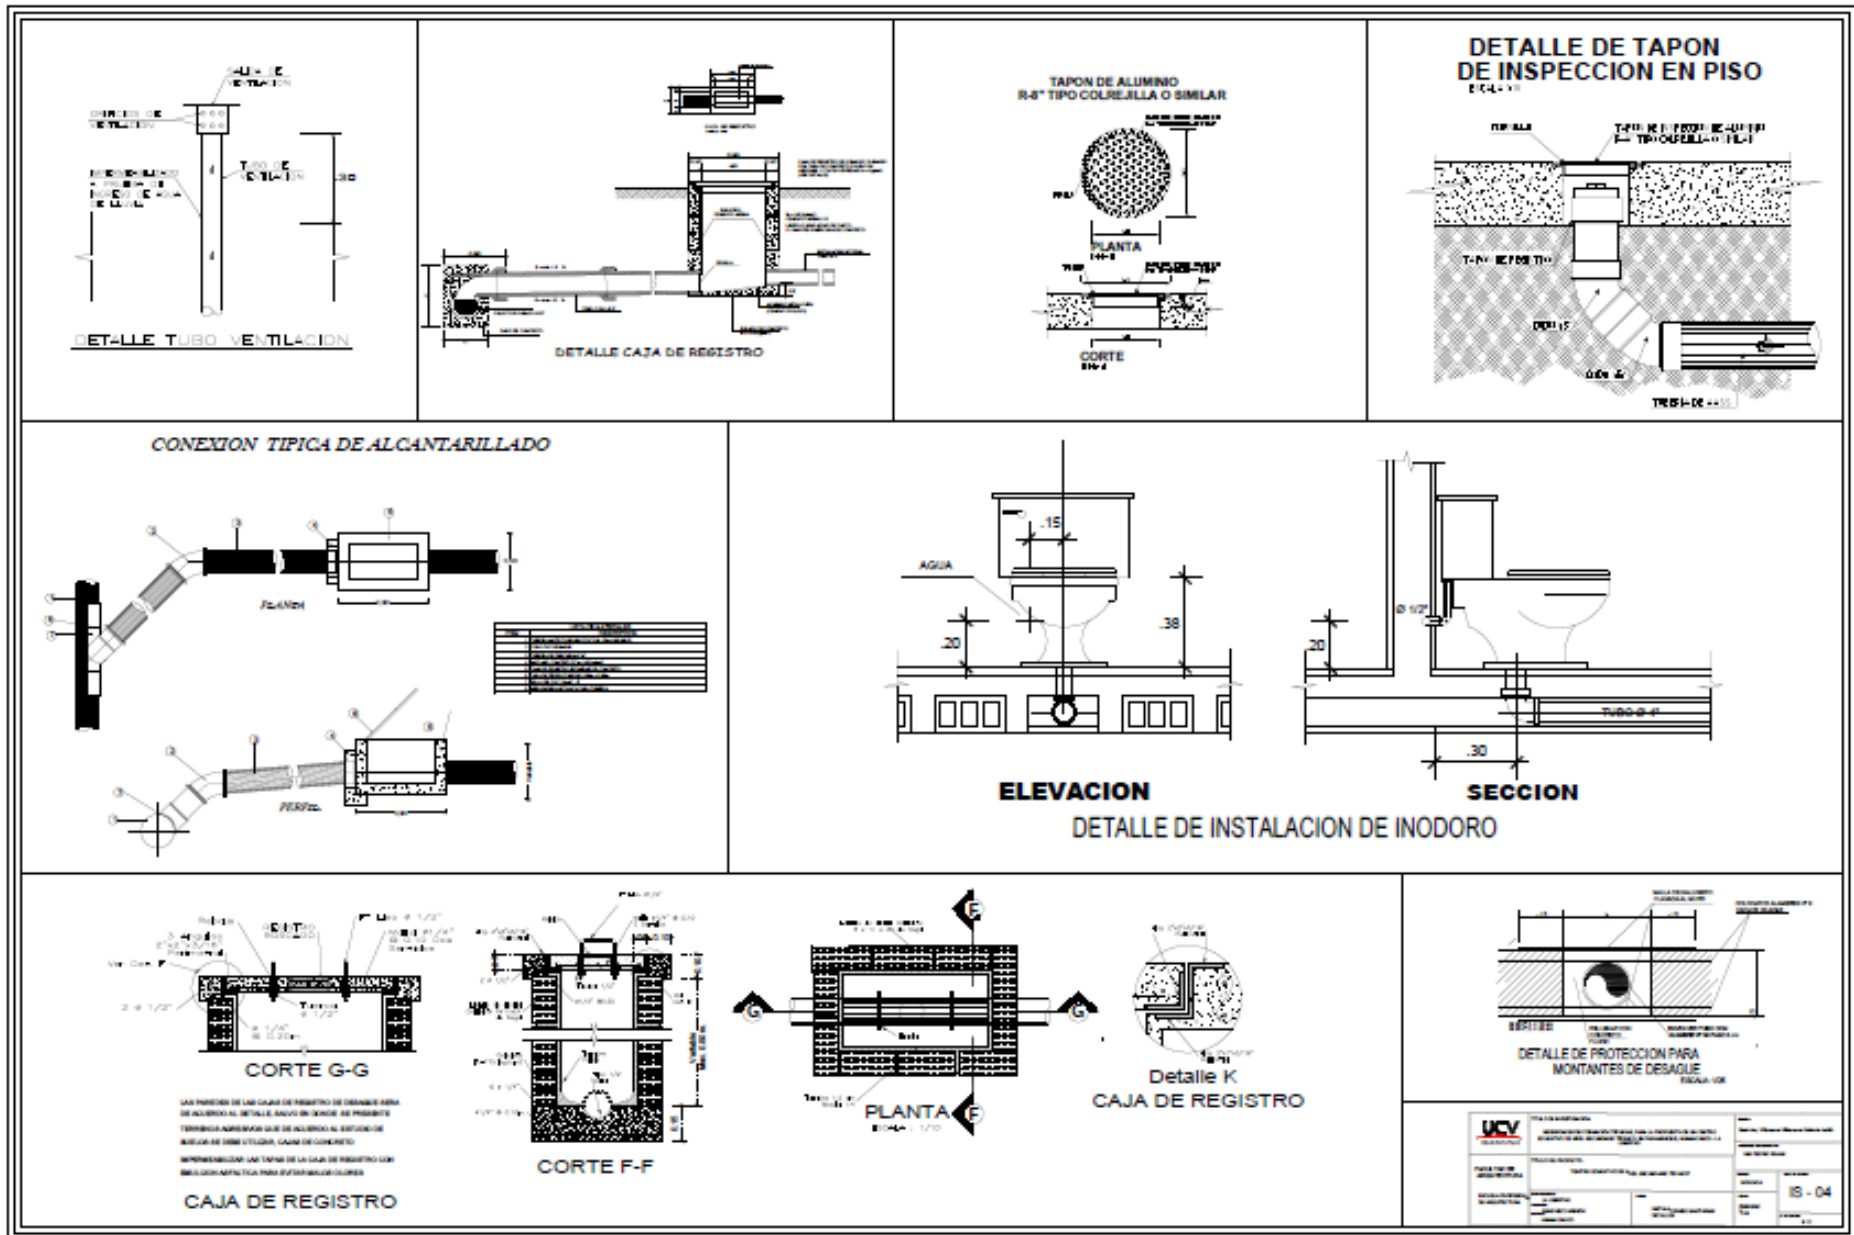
Plano de Diseño de Instalaciones Básicas Detalles– Desagüe - Plano N° 24 - Lamina IS-04
